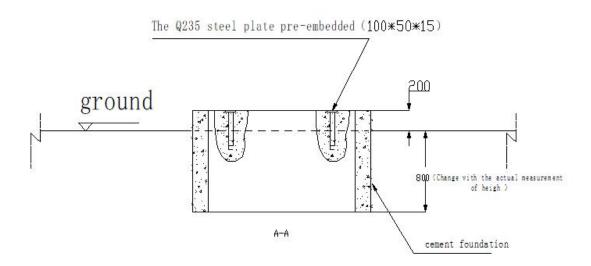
Diagrama esquemático de la construcción de la cimentación.
